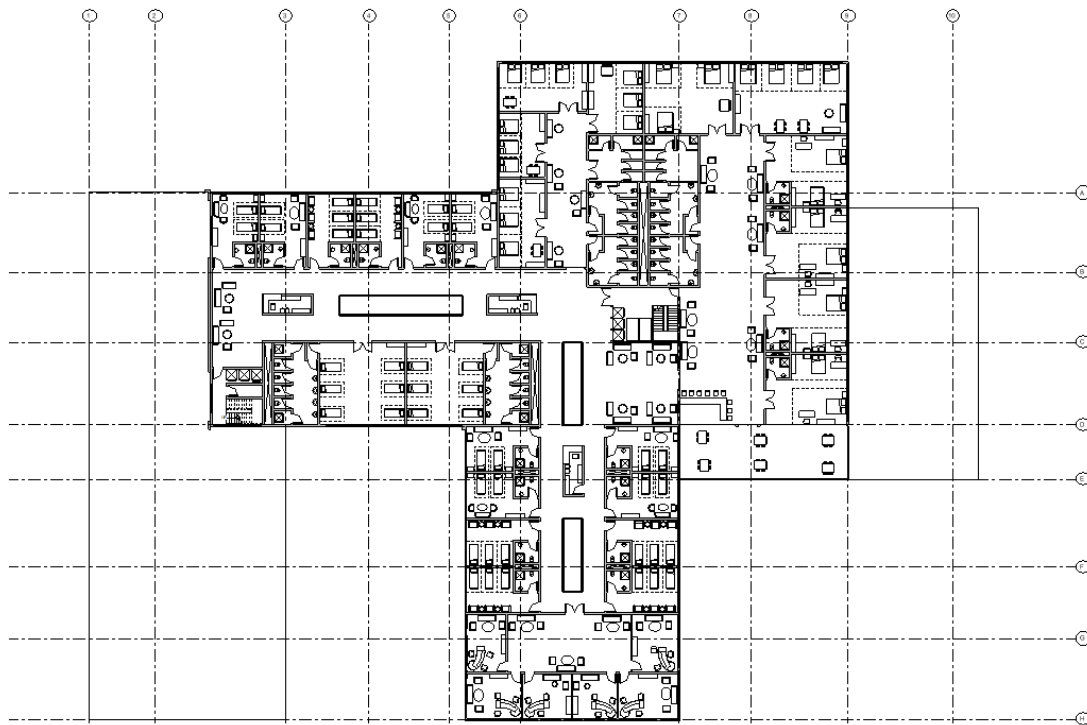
Архітектурний план для 2 поверху лікарні
